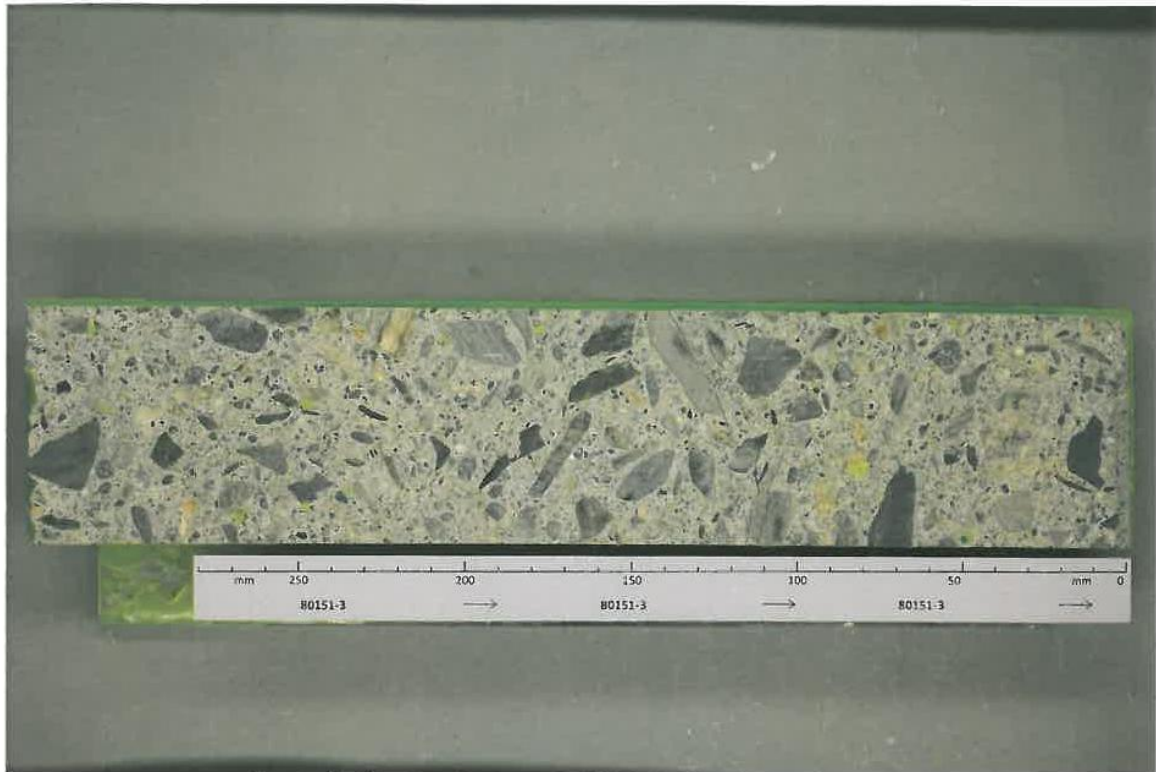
Planslipet fra kjerne Nr 3. Overflaten til høyre på bildet.
